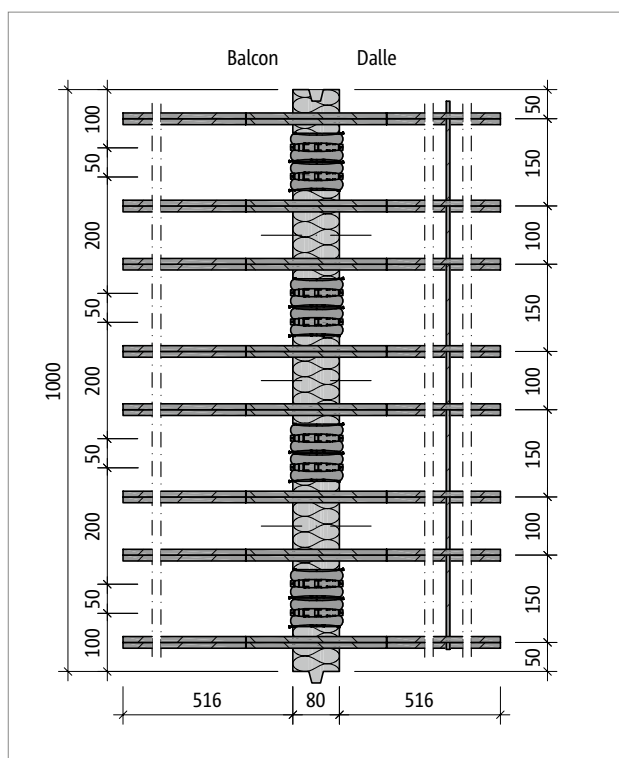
Schöck Isokorb® T type Q-E-VV5 : plan de base du produit
